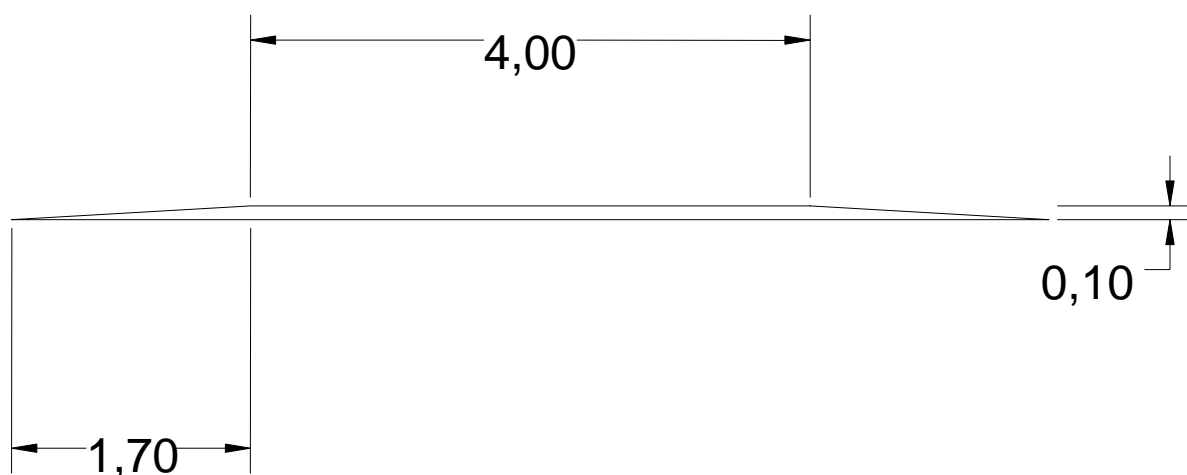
Corte transversal da travessia pedonal elevada com as respetivas medidas em metros, pormenor realizado em Autocad
